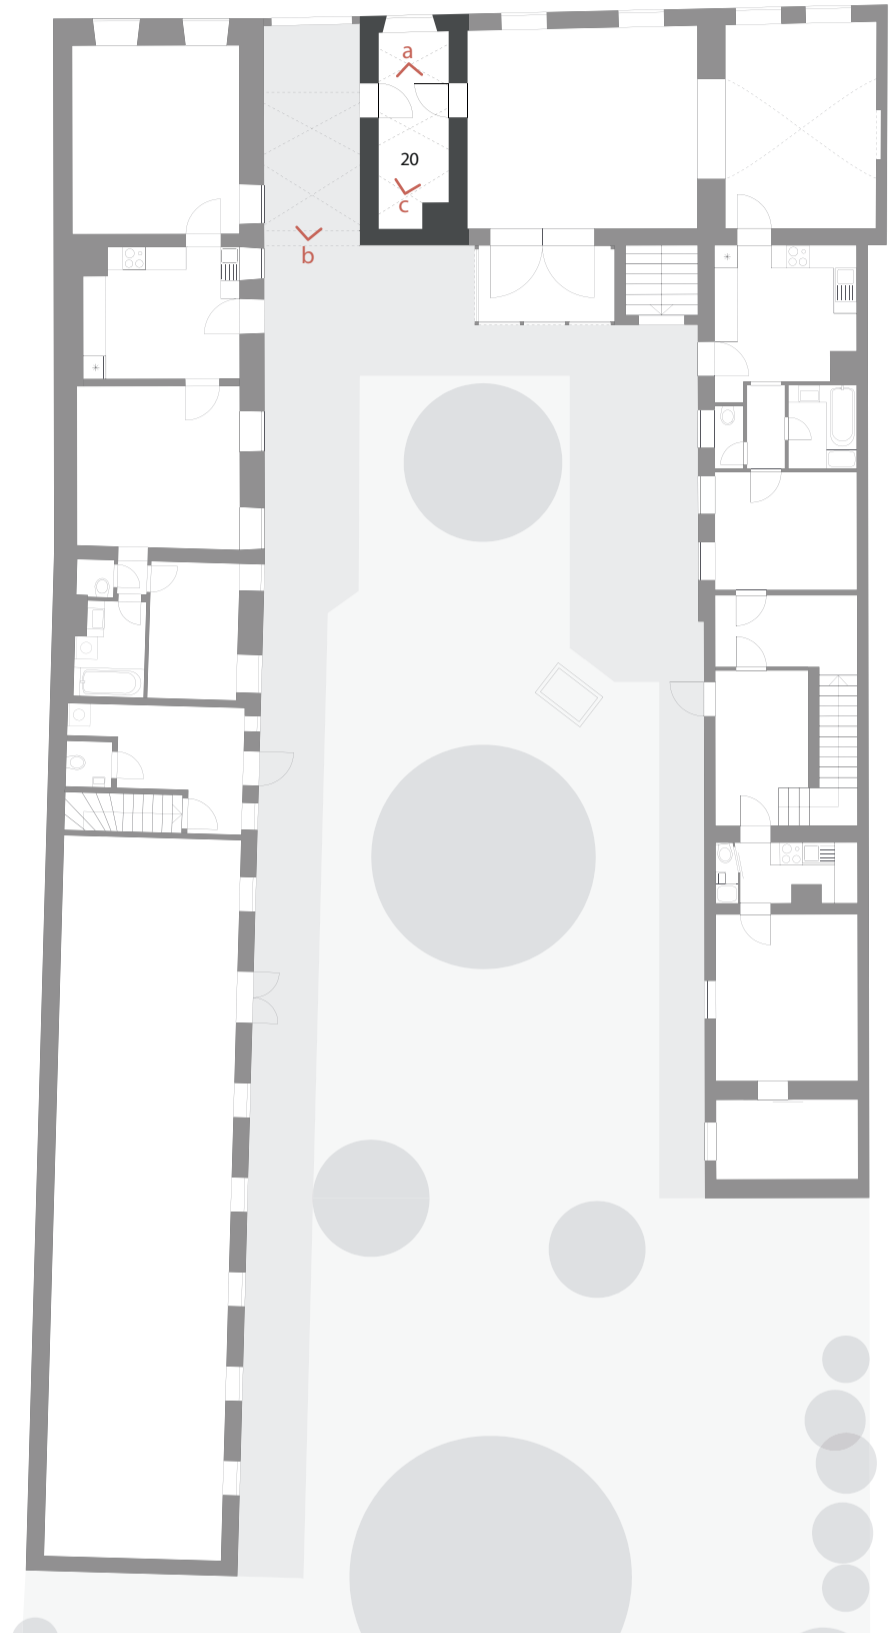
Grundriss Erdgeschoß | M 1:200 | Raum 20
